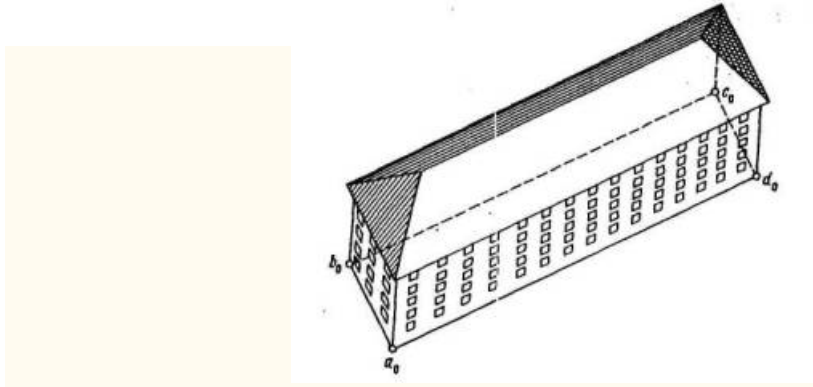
Определение основания здание по двум видимым на фотоплане сторонам
